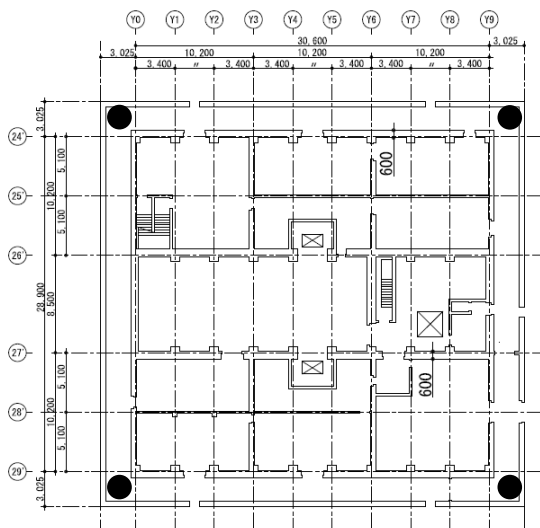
(1) 地震計配置 (HAW 建家 断面図)
